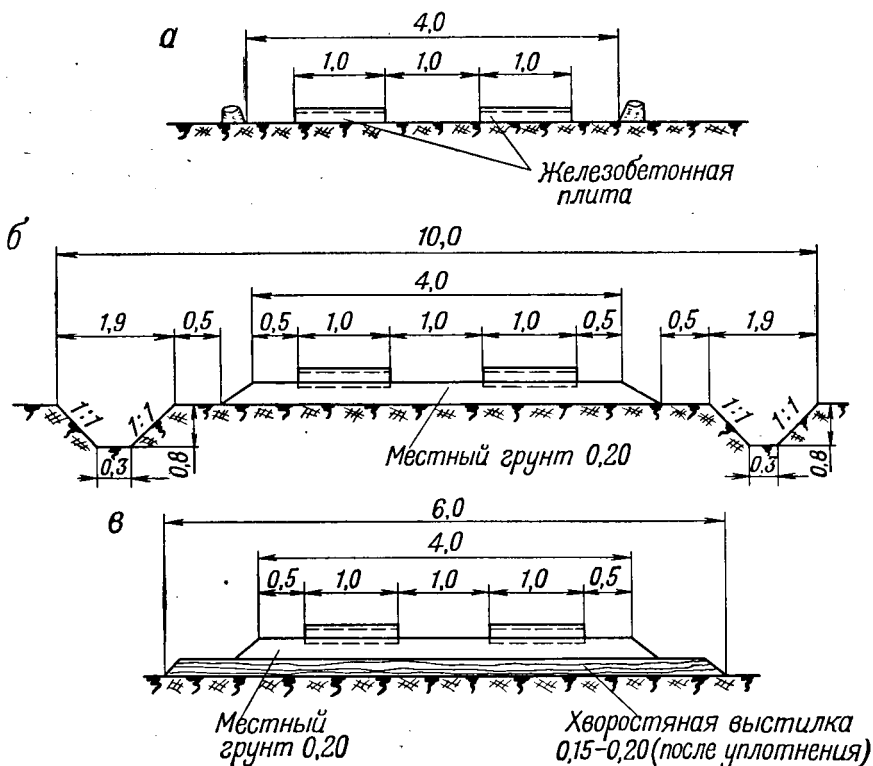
Поперечные профили усов с железобетонным покрытием:
